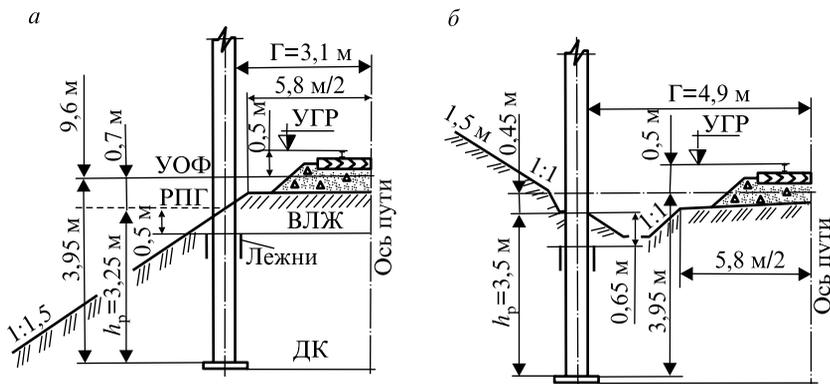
Схема установки опор длиной 13,6 м на насыпи (*a*) и в выемке (*б*); РПГ — расчетная поверхность грунта; ВЛЖ — верх лежней; ДК — дно котлована
